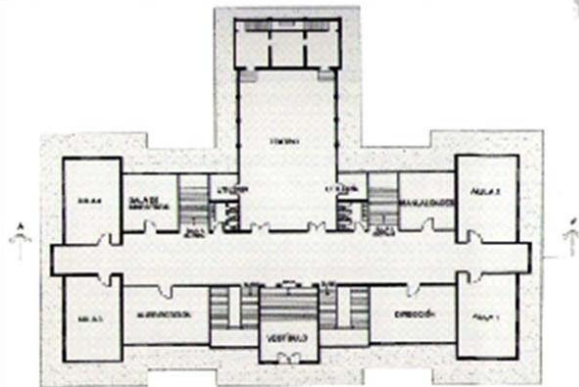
, 16: Planos arquitectónicos de la planta baja y alta de la antigua escuela Benito Juárez.
